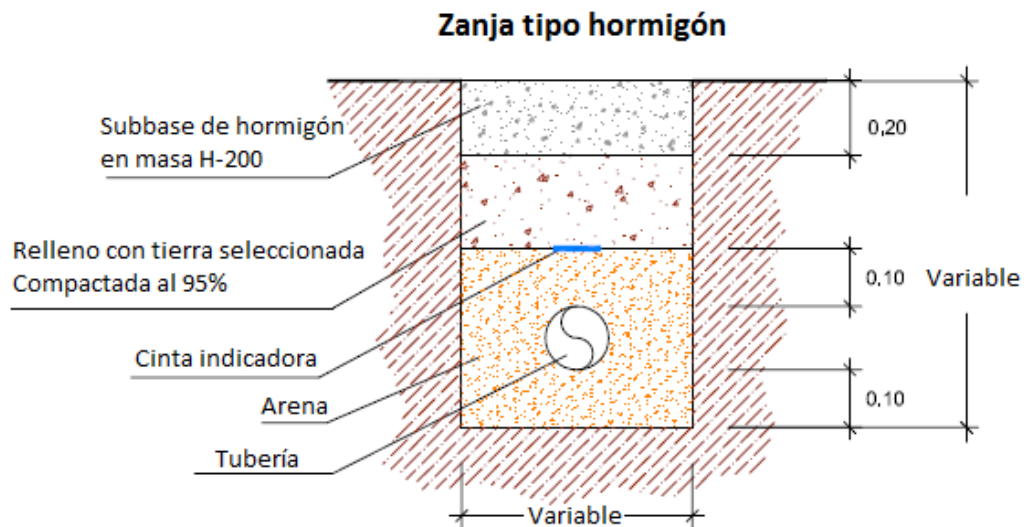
Zanja tipo hormigón (dimensiones en metros). [Fuente: SOREA, SAU].
